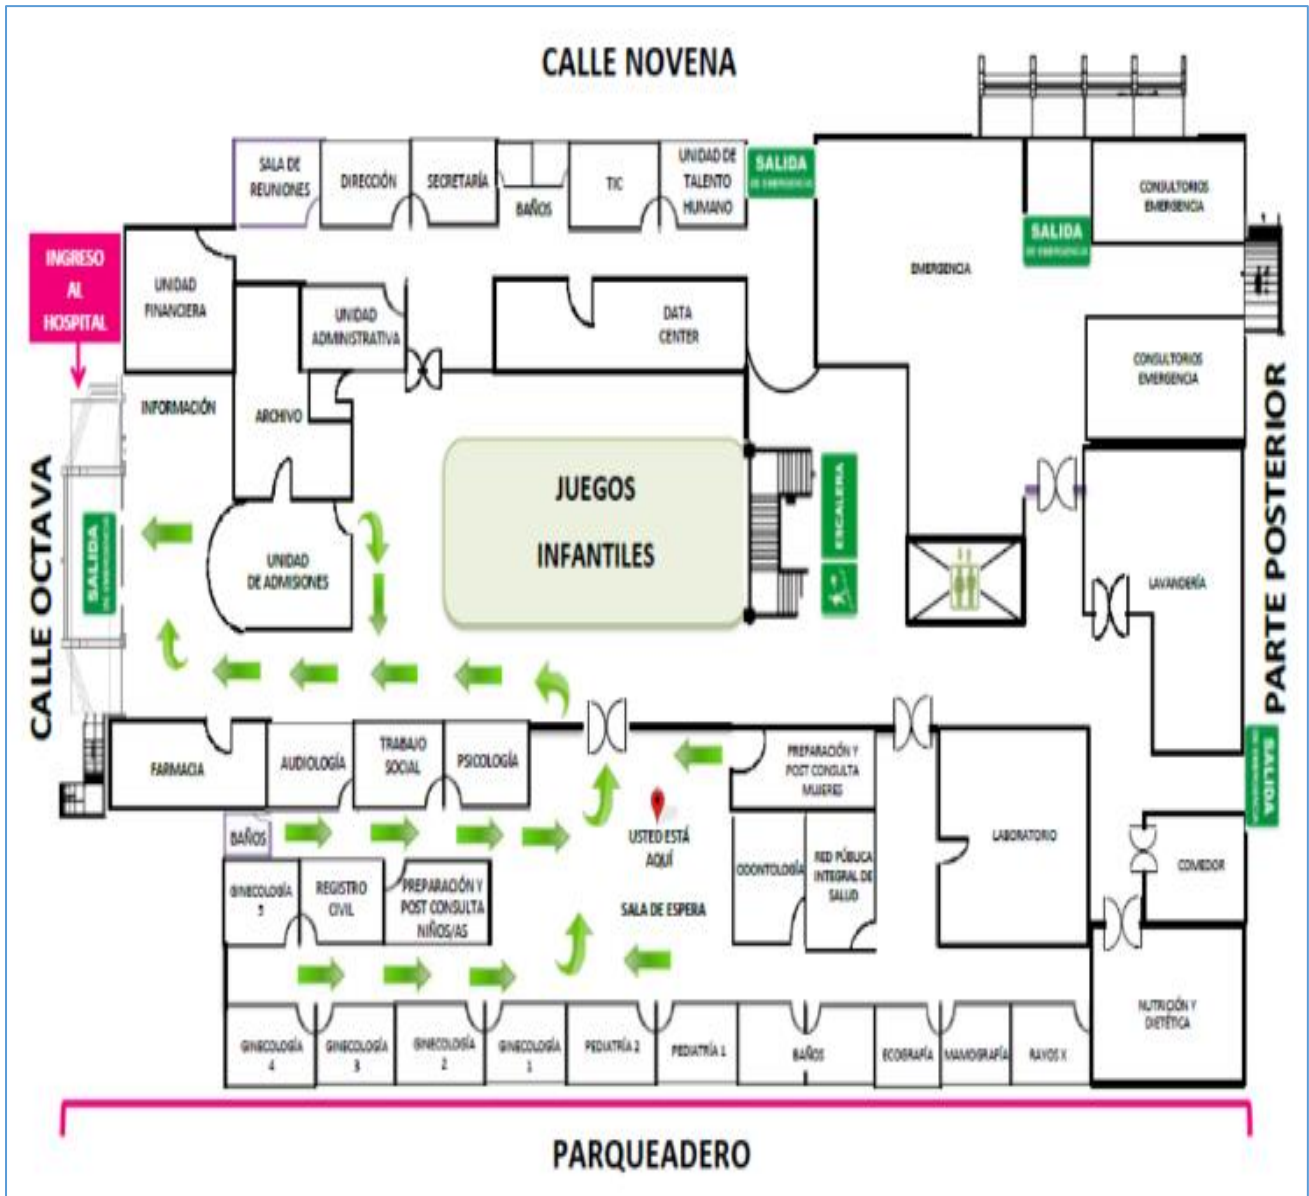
Mapa de Rutas de evacuación Planta baja Laboratorio – lavandería
